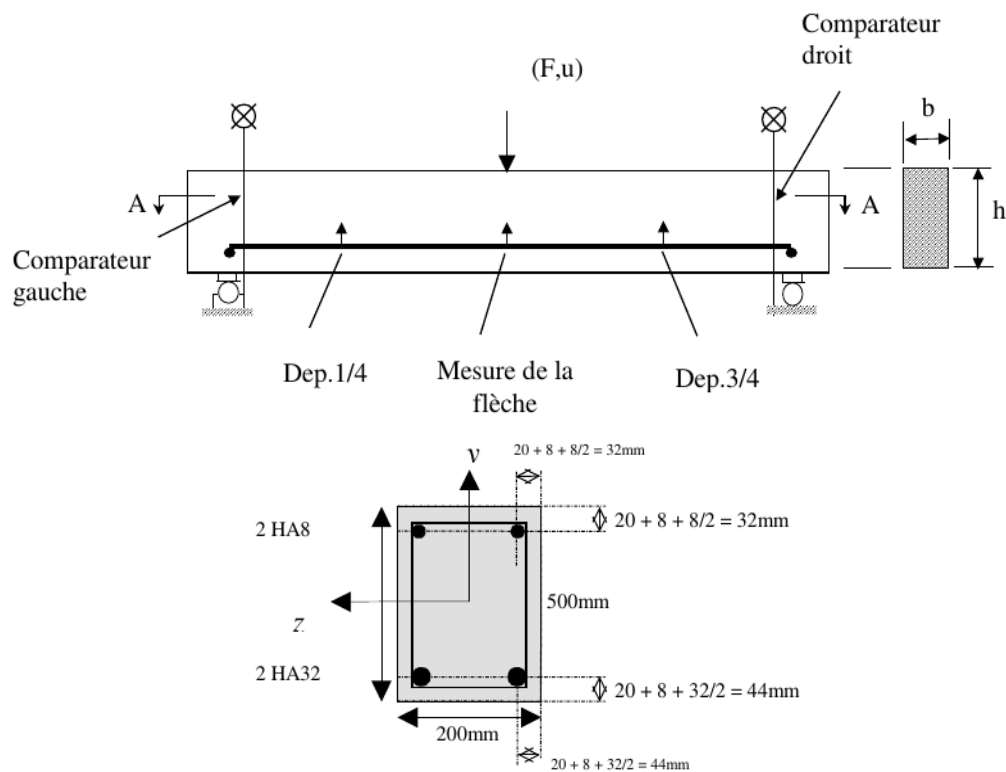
Géométrie et plan de ferrailage de l'essai CEOS.FR (Jason, 2009).
